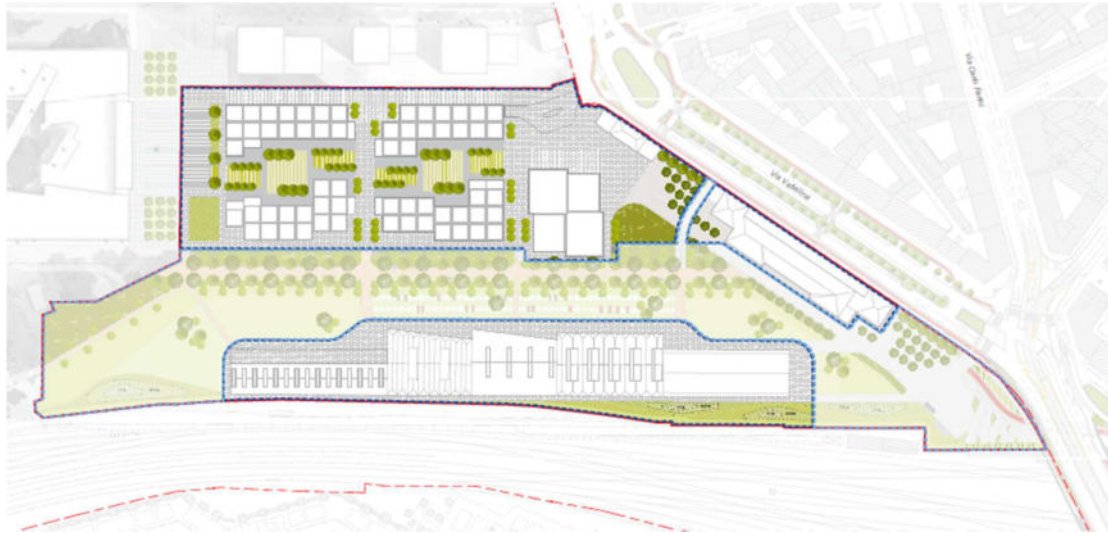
planimetria delle aree asservite (fonte: elaborato 7.2.1)
